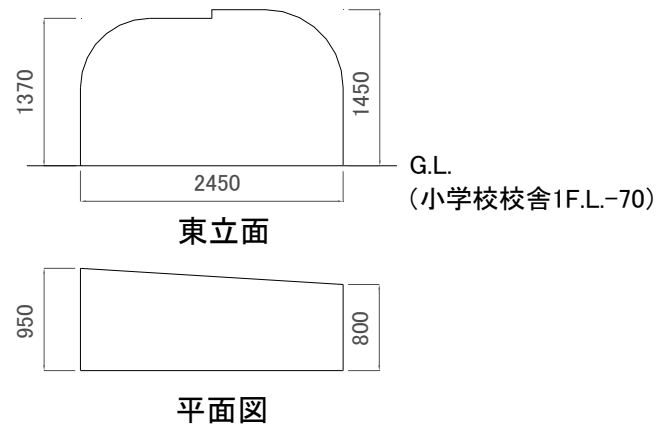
石碑の立面図・平面図 (単位: mm)
